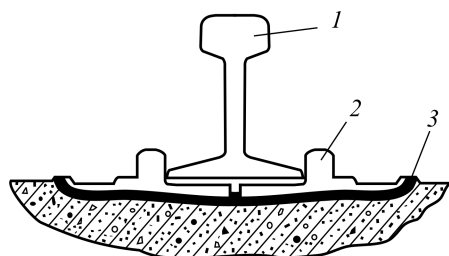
Кромочное опирание подошвы рельса после излома подкладки:
